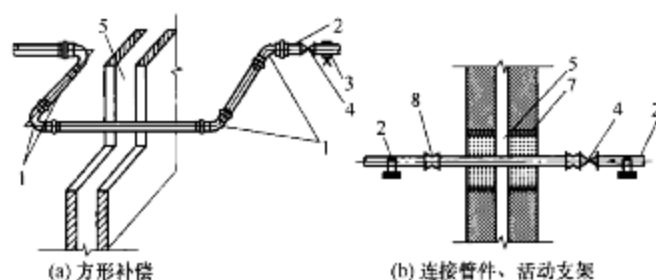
管道穿越沉降缝、伸缩缝和变形缝的施工方法示意图
